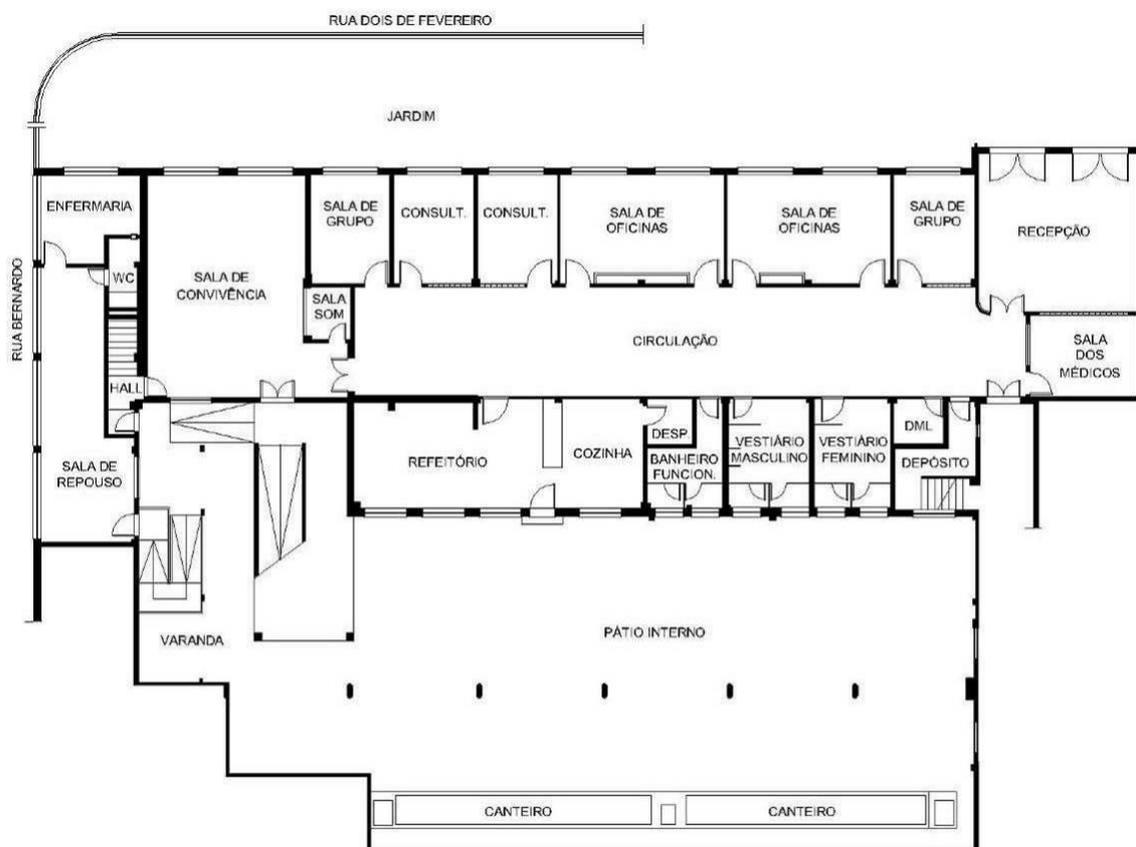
Planta do CAPSad II Raul Seixas - pavimento térreo.
